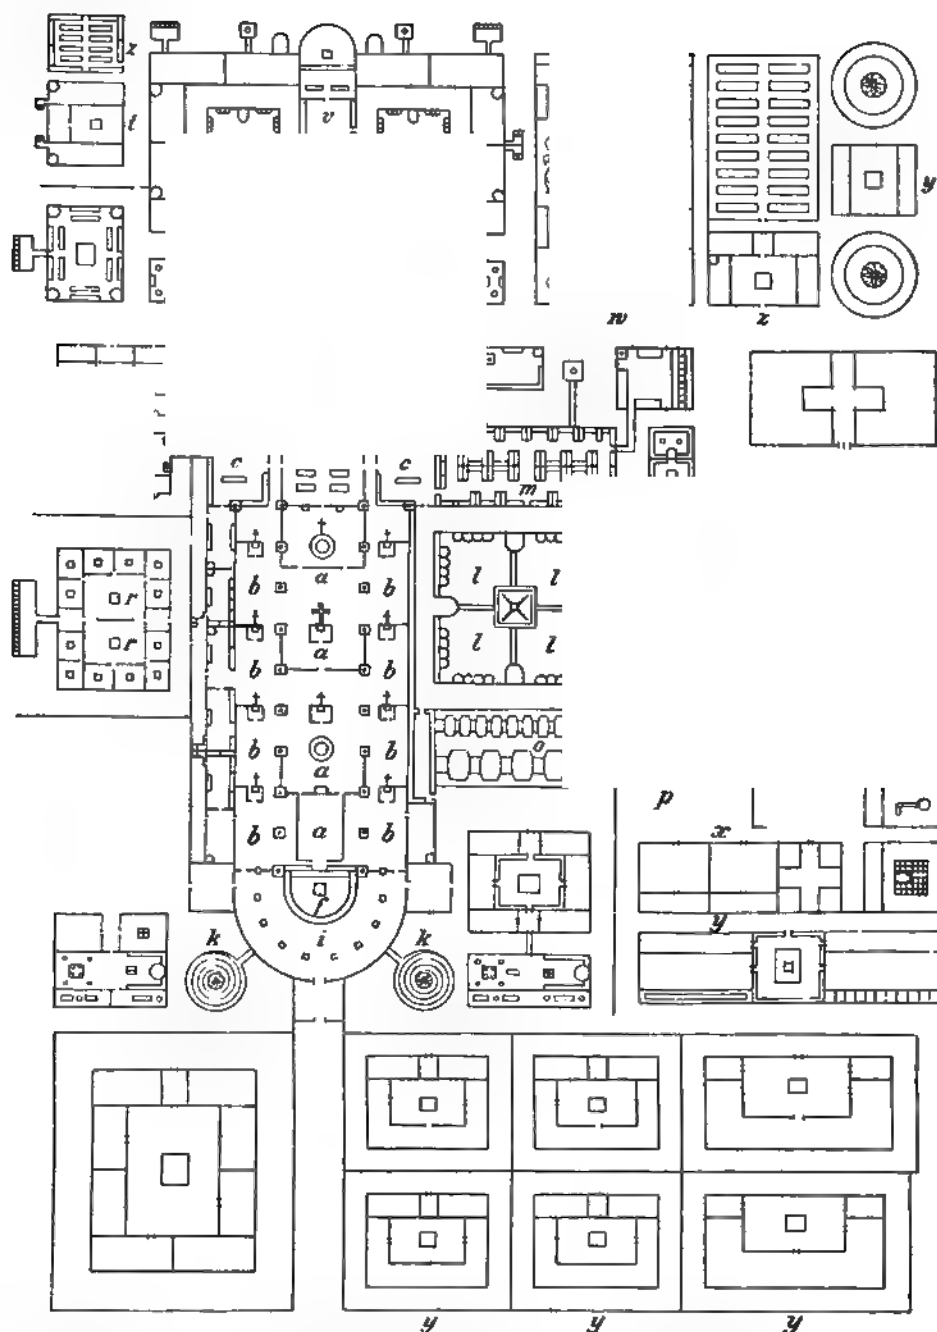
Bauriss des Klosters St. Gallen vom Jahre 820
